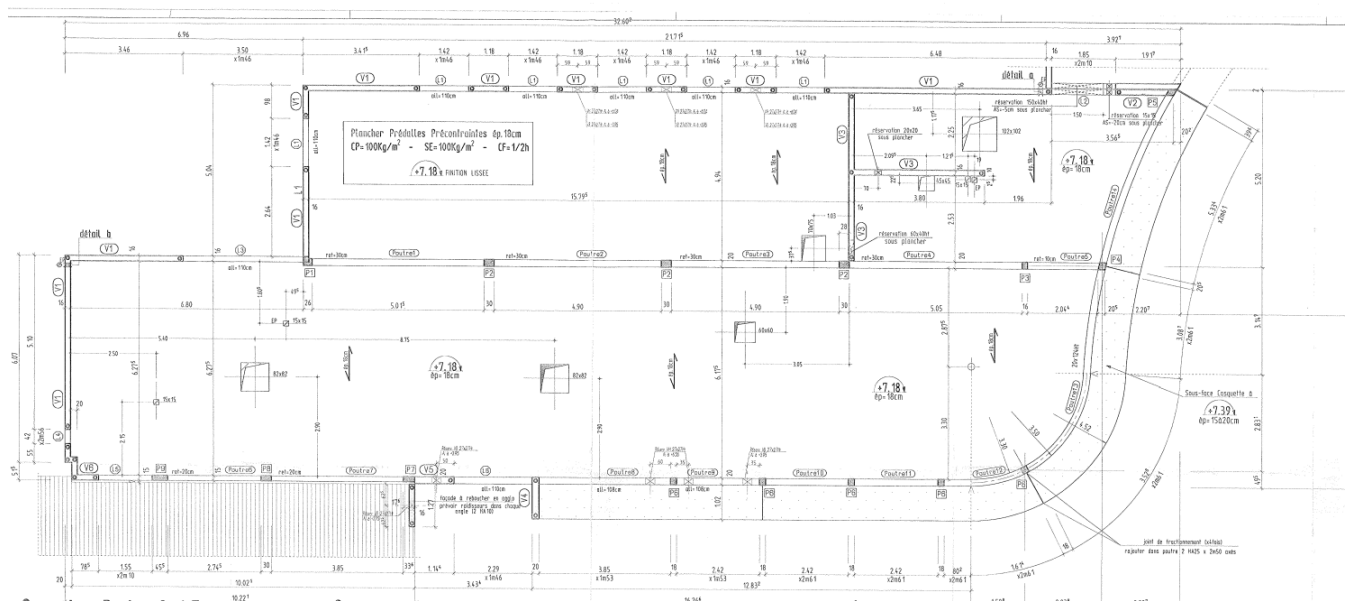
Extrait Coffrage Etage R+1, zone Sud / Plan SERBA 96.158 – EXE15C
